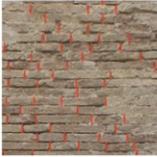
Indicazione campioni IQM - Prospetto Nord Piazza Barbacani
